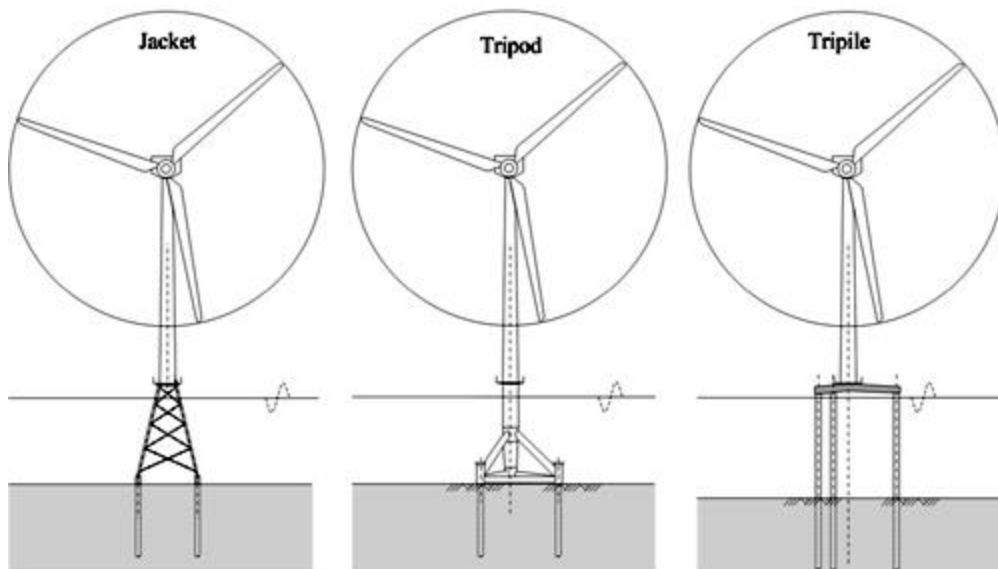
Esquema comparativo de las estructuras de tipo "Jacket", trípode y tripilote.
